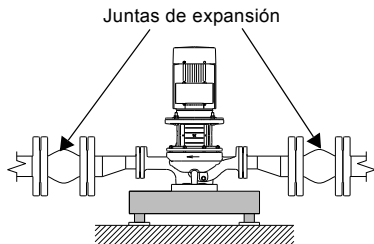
Bomba TP instalada con juntas de expansión más grandes
